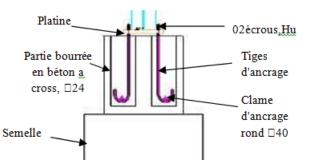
Détail n°01: Articulation pied de poteau- fondation (1/50)
